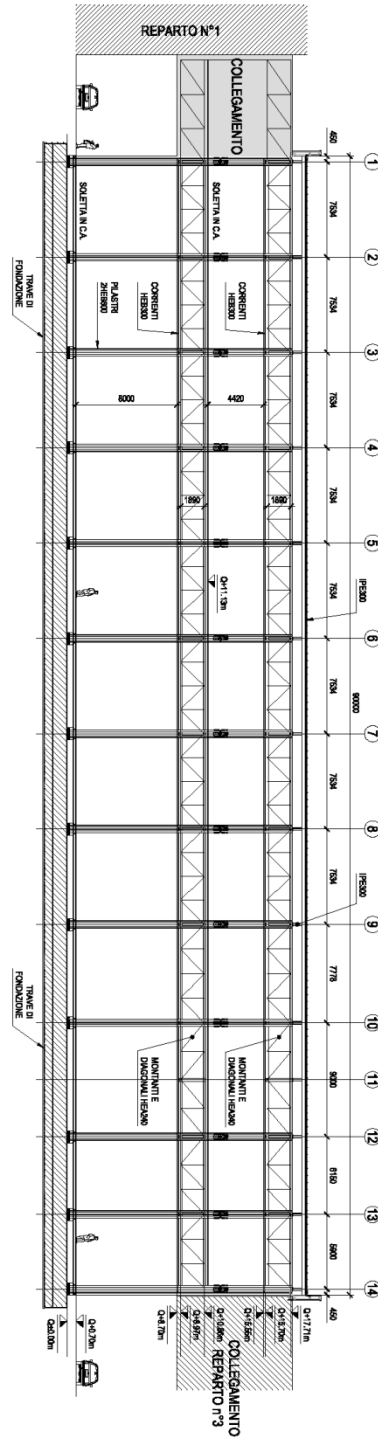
Sezione longitudinale tipo struttura di elevazione
